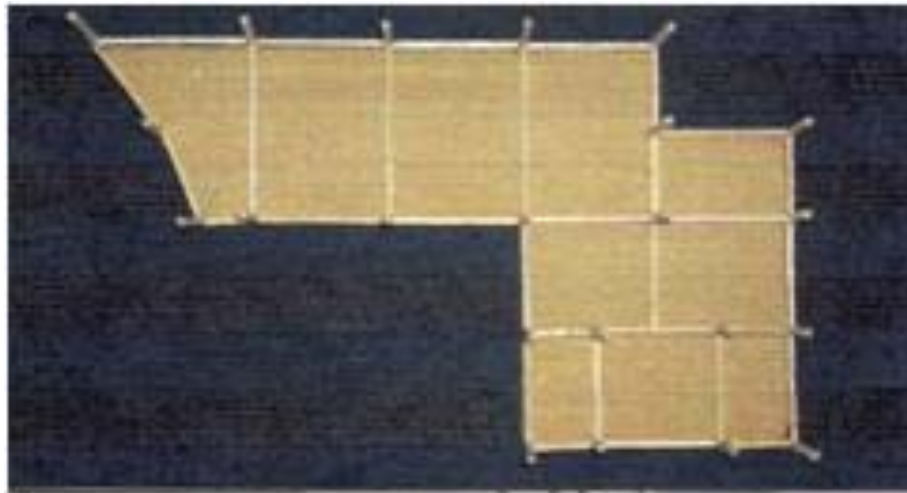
Vista en planta de las trabes y columnas del edificio B.
